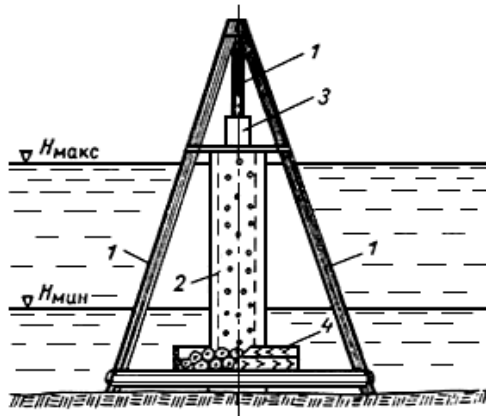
Установка СУВ островного типа в деревянной опорной конструкции для грунтов, не допускающих забивку свай
